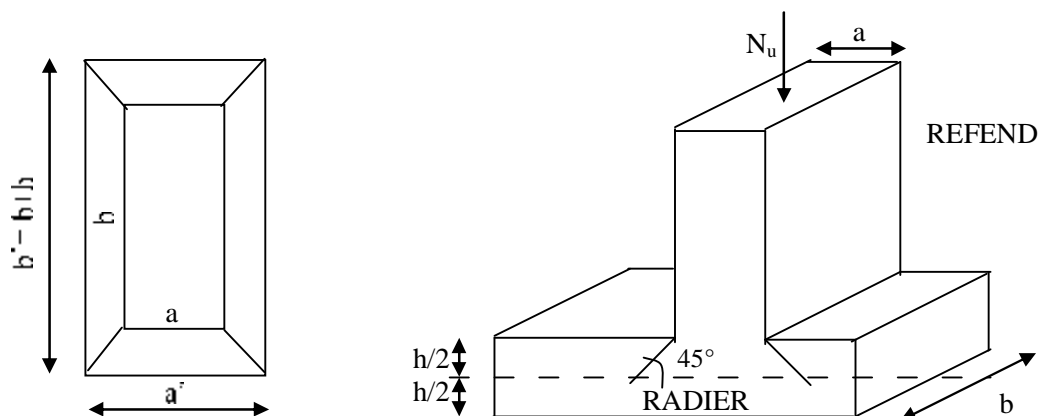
Périmètre utile des voiles et des poteaux
